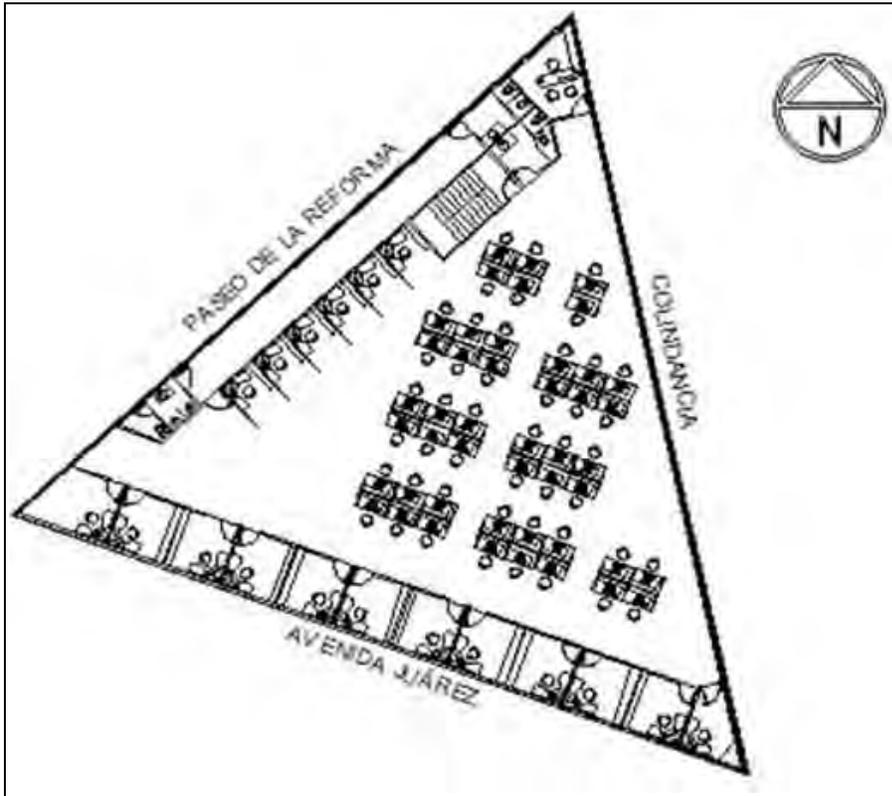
Croquis en planta del piso 25 de la Torre Prisma.
